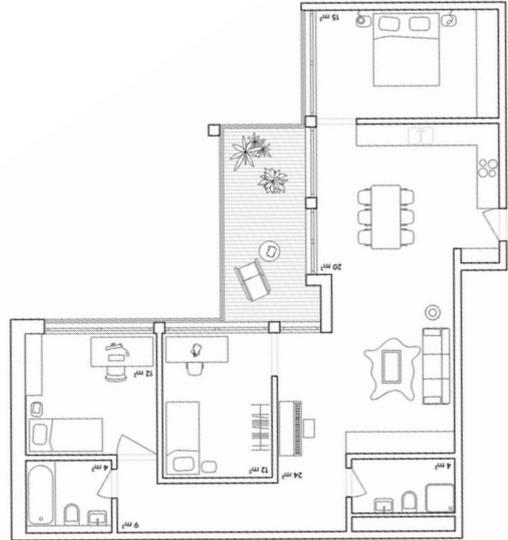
Wohnungsgrundriss 4 Zimmer - Whg.
